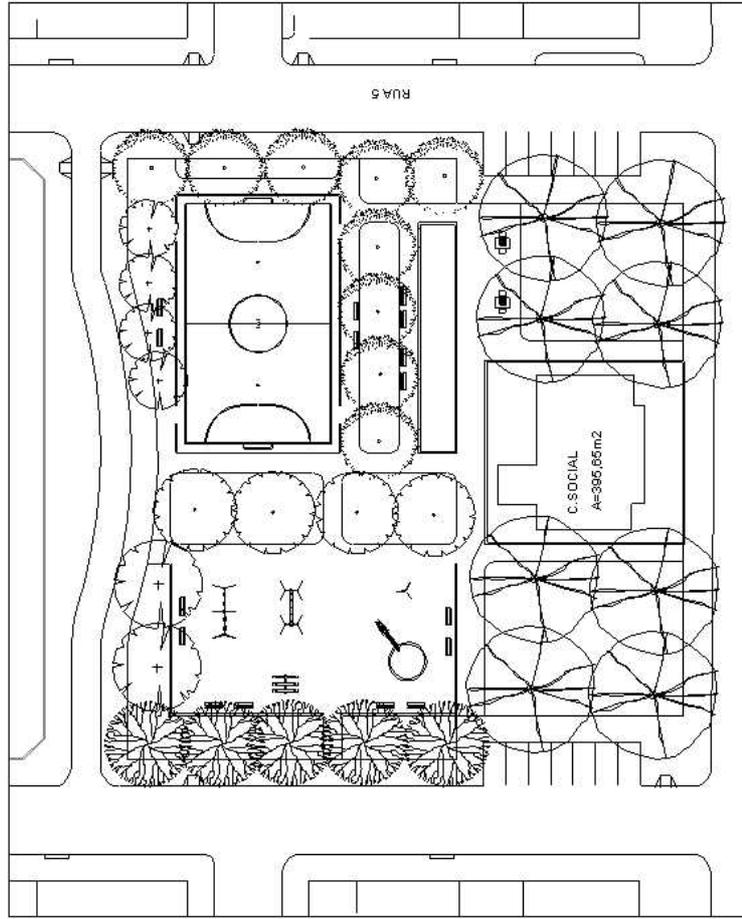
PRAÇA PLANTA DE OBRA esc. 1:750
